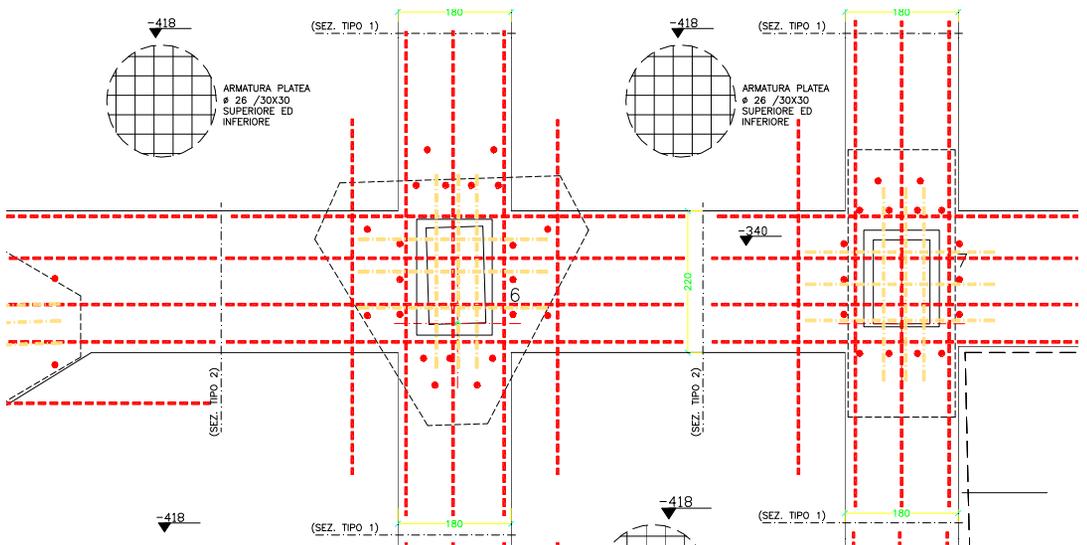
Schema intervento strutturale di messa in esercizio della nuova fondazione
